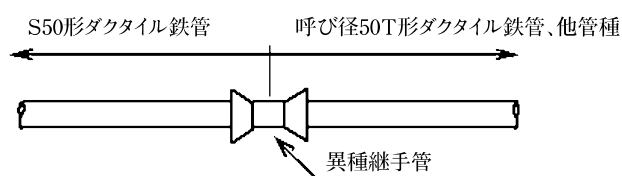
呼び径50T形ダクタイトイル鉄管や他管種との接続方法例
